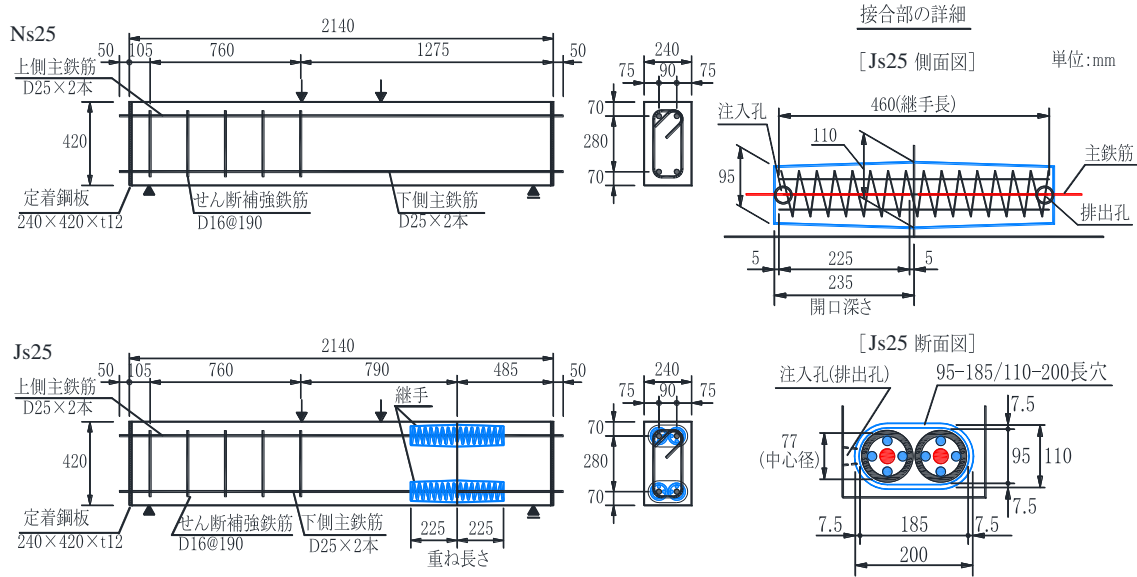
試験体の形状寸法と配筋 (D25 シリーズ)
